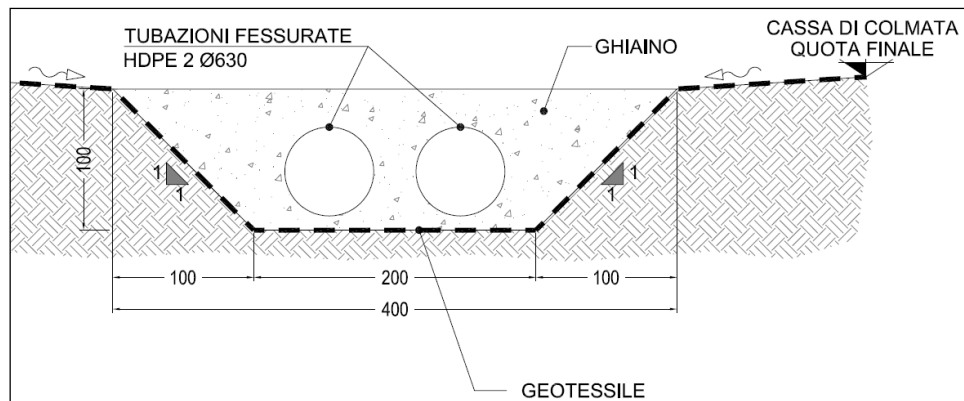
Area 8 - Sezione tipologica trincea drenante
